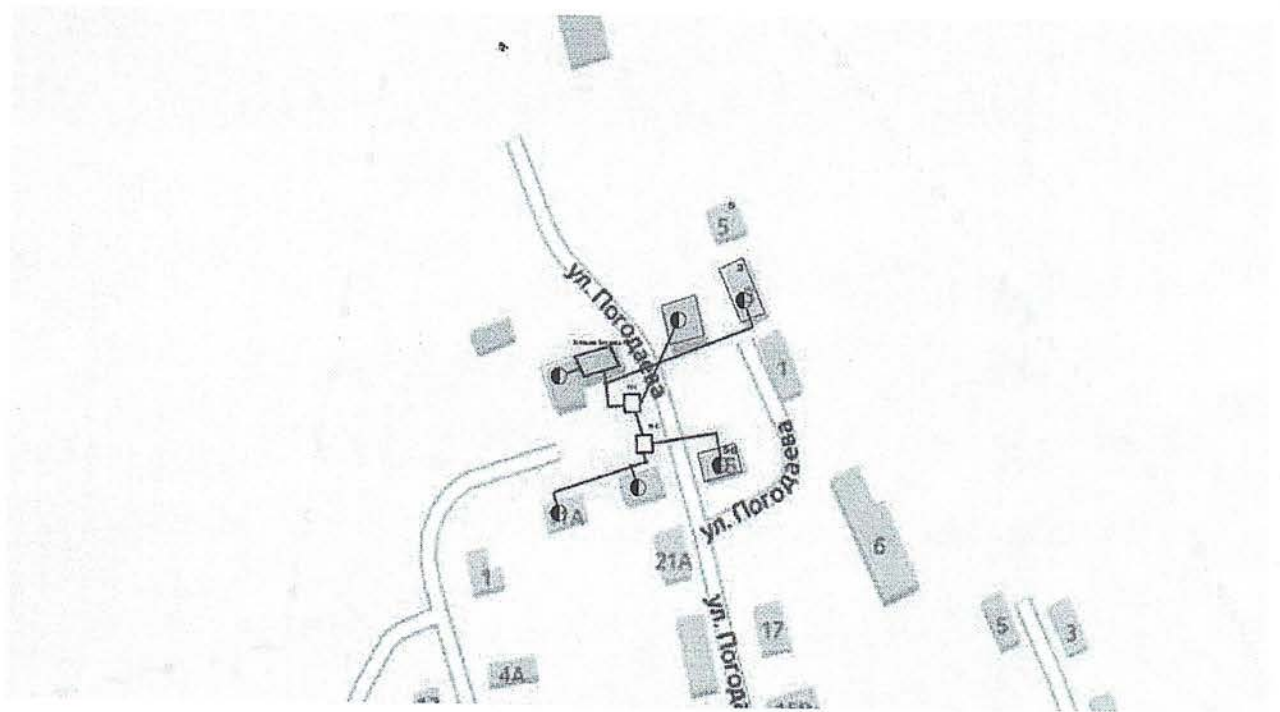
Схема теплоснабжения от котельной Погодаева УП
